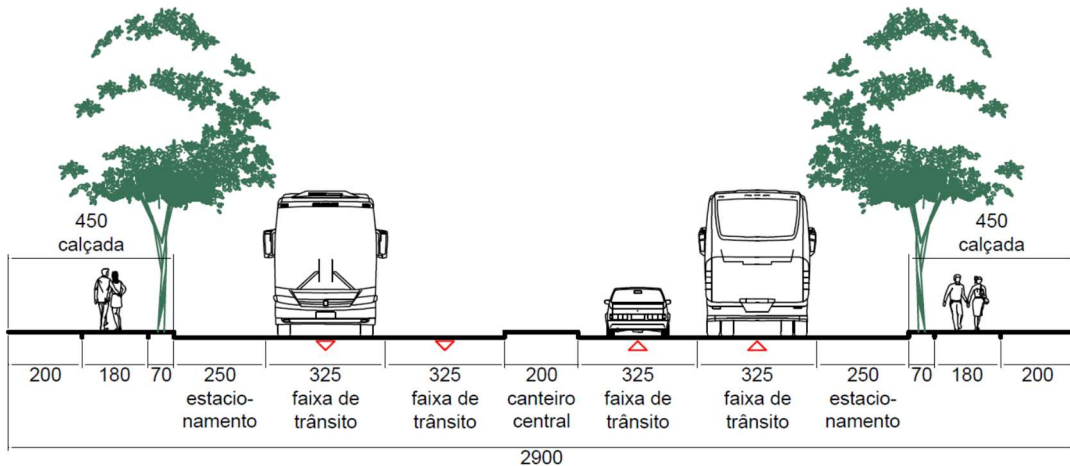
Perfil transversal via perimetral (medidas em centímetros)
